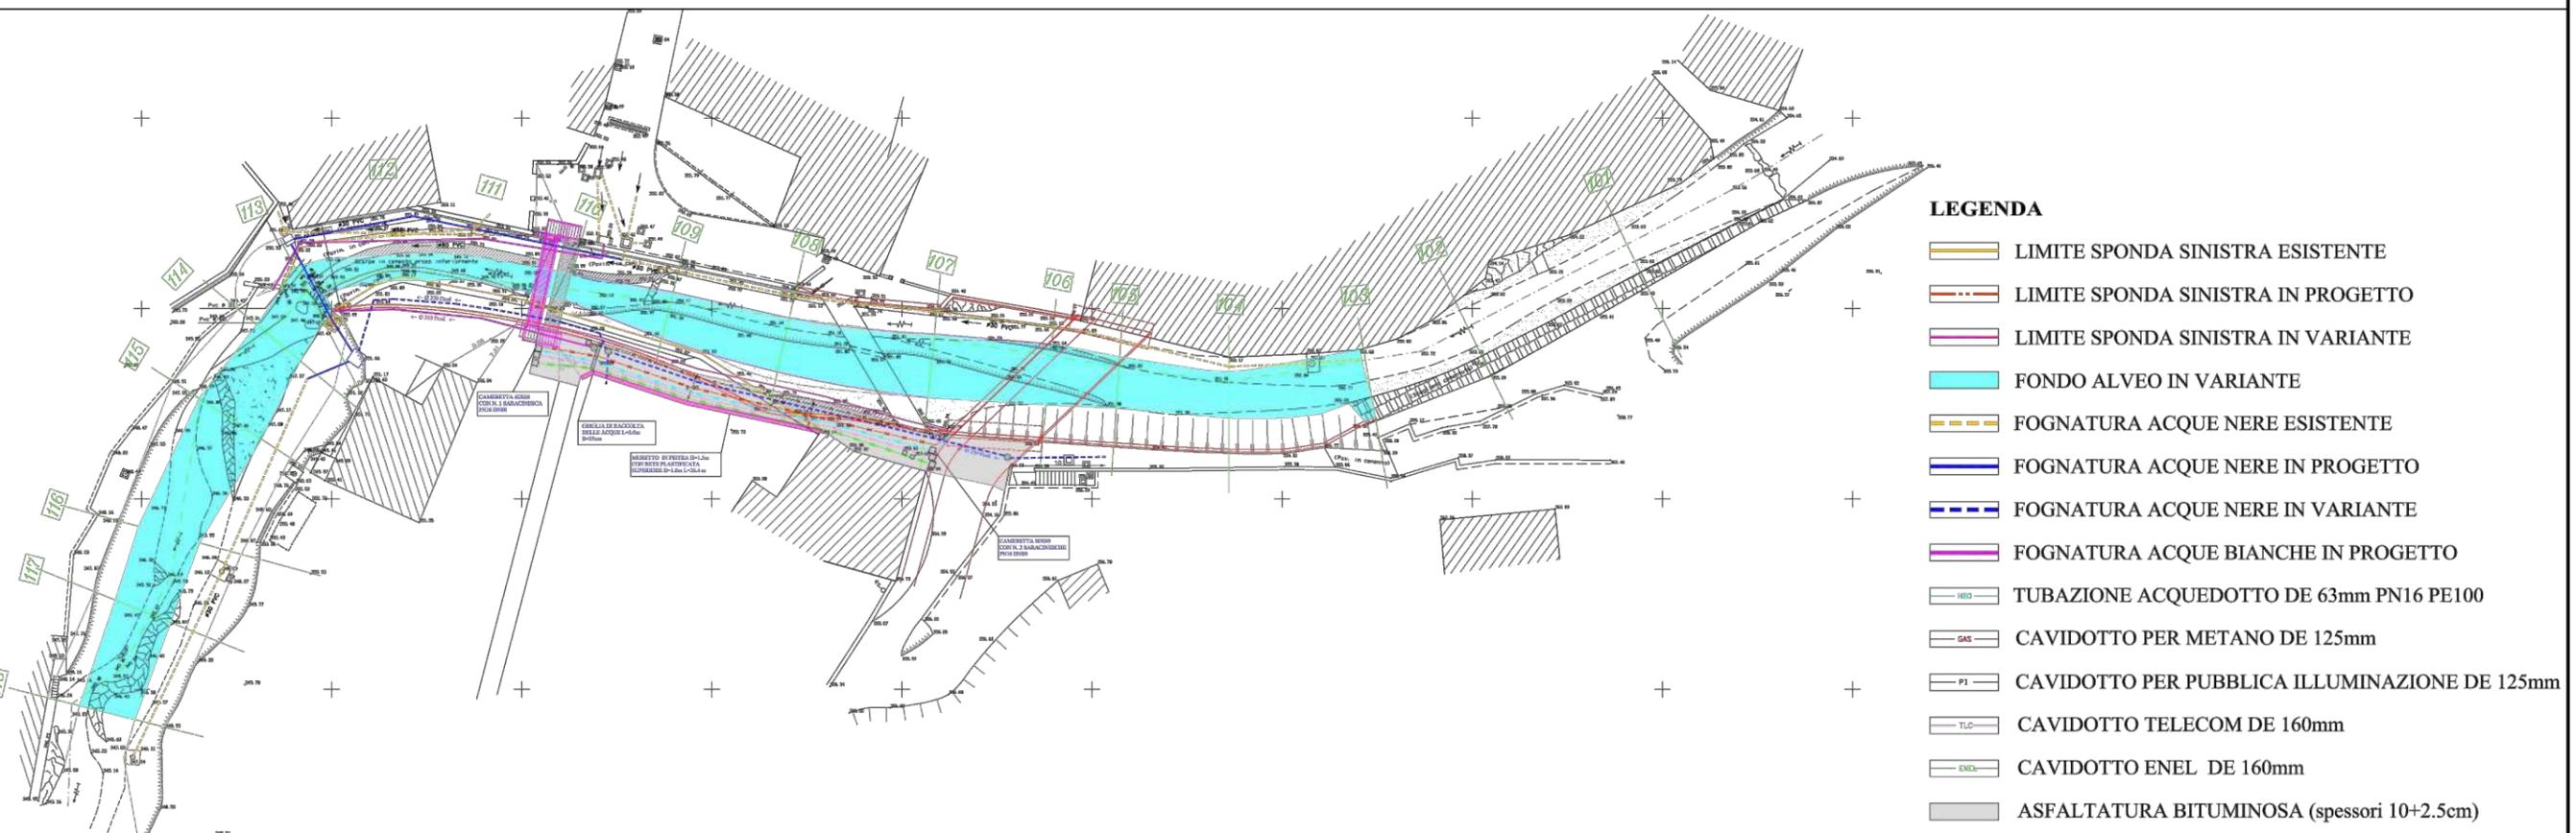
PLANIMETRIA OPERE IN PROGETTO
